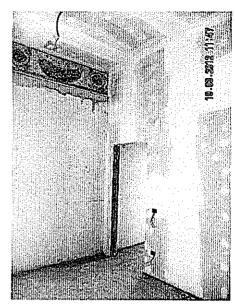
Stanza 1.4- Vista interna.porta accesso sala (stanza 1.5).
